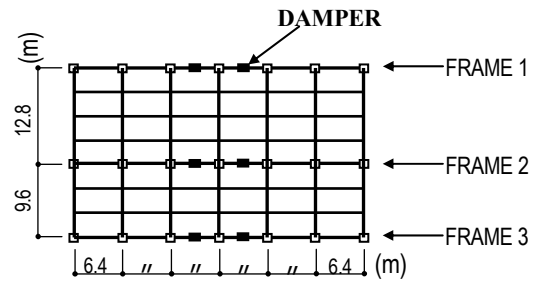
平面およびダンパーの配置 (Structural Plan and Damper Locations)
